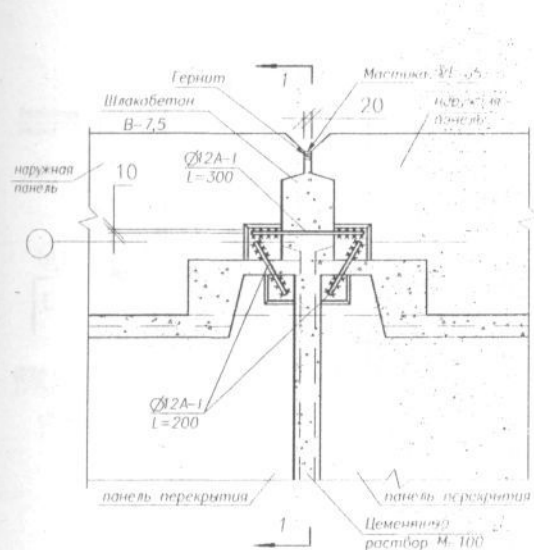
Стык рядовых наружных панелей и панелей перекрытия
